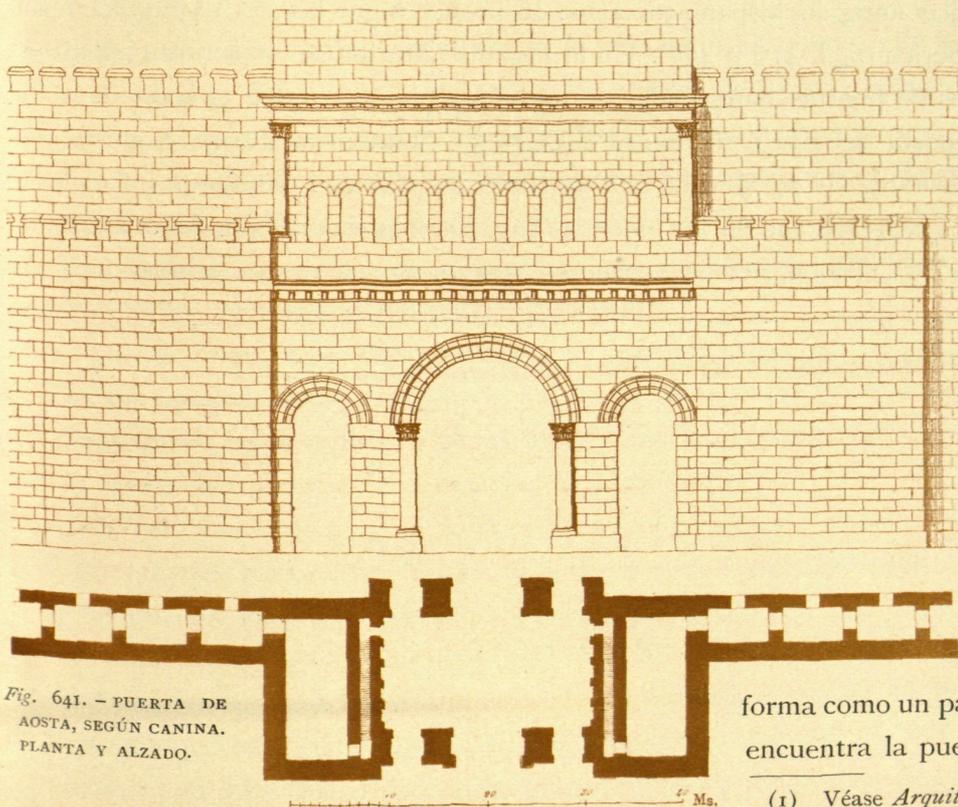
PUERTA DE AOSTA, SEGÚN CANINA. PLANTA Y ALZADO.
